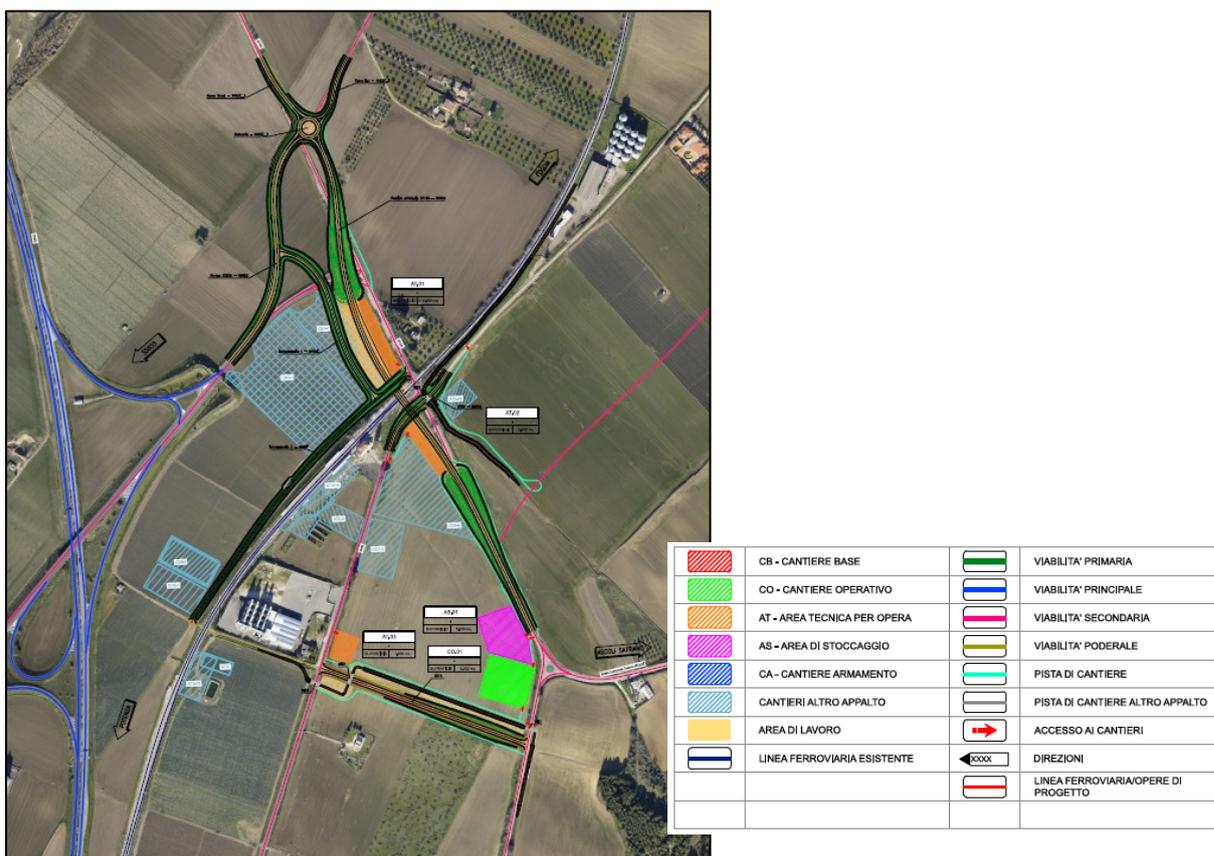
Localizzazione aree di cantiere (Fonte: Allegato 62 alla Lista di controllo - Planimetria delle aree di cantiere e della viabilità connessa)
